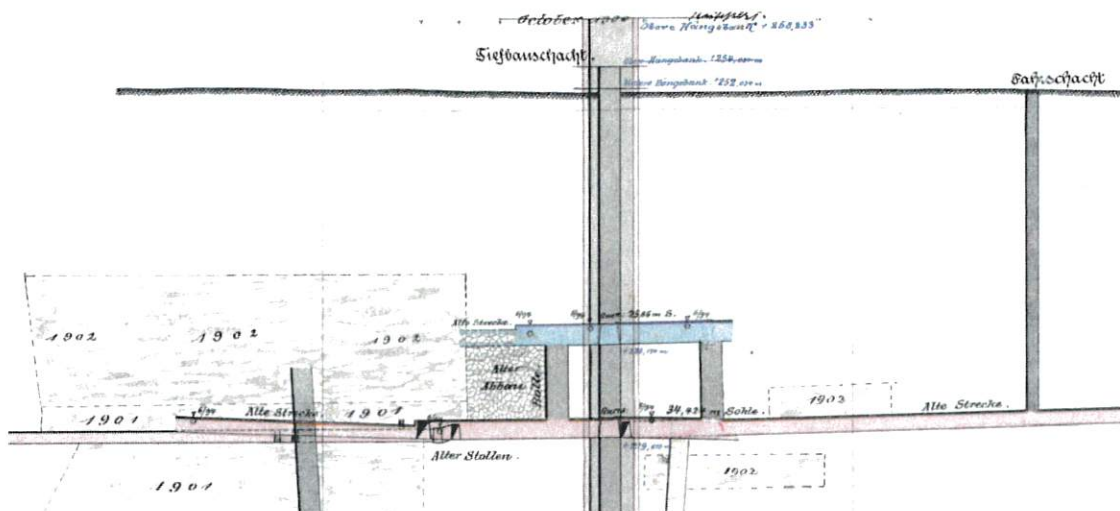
Seigerriss Gang 1, Detailansicht Tiefbauschacht 1 26 m Sohle und 34 m Sohle
